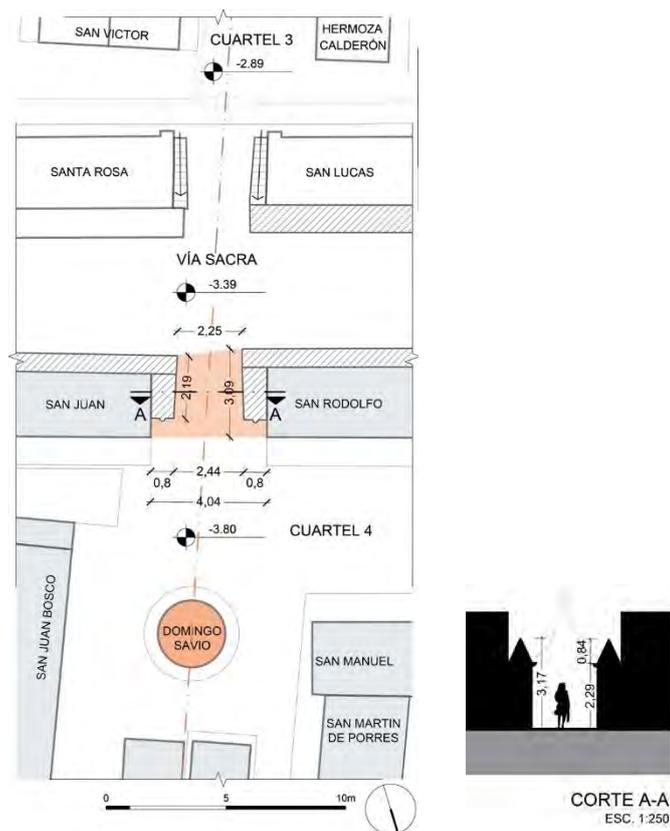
Plano de planta del umbral de acceso al cuartel cuatro del CRLAC. Se observa en color melón el espacio de transición y a los costados los pilares con remate piramidal. Corte A-A del plano de planta del umbral de acceso al cuartel cuatro del CRLAC.
